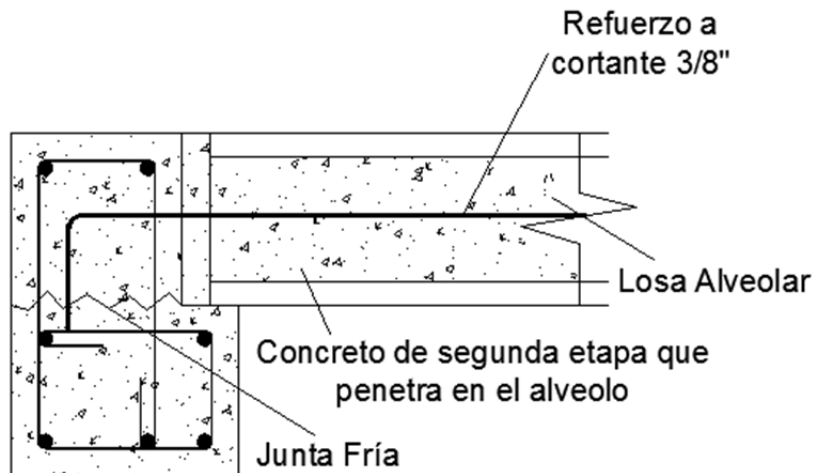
Ensayo tipo 2, junta armada con refuerzo transversal.
